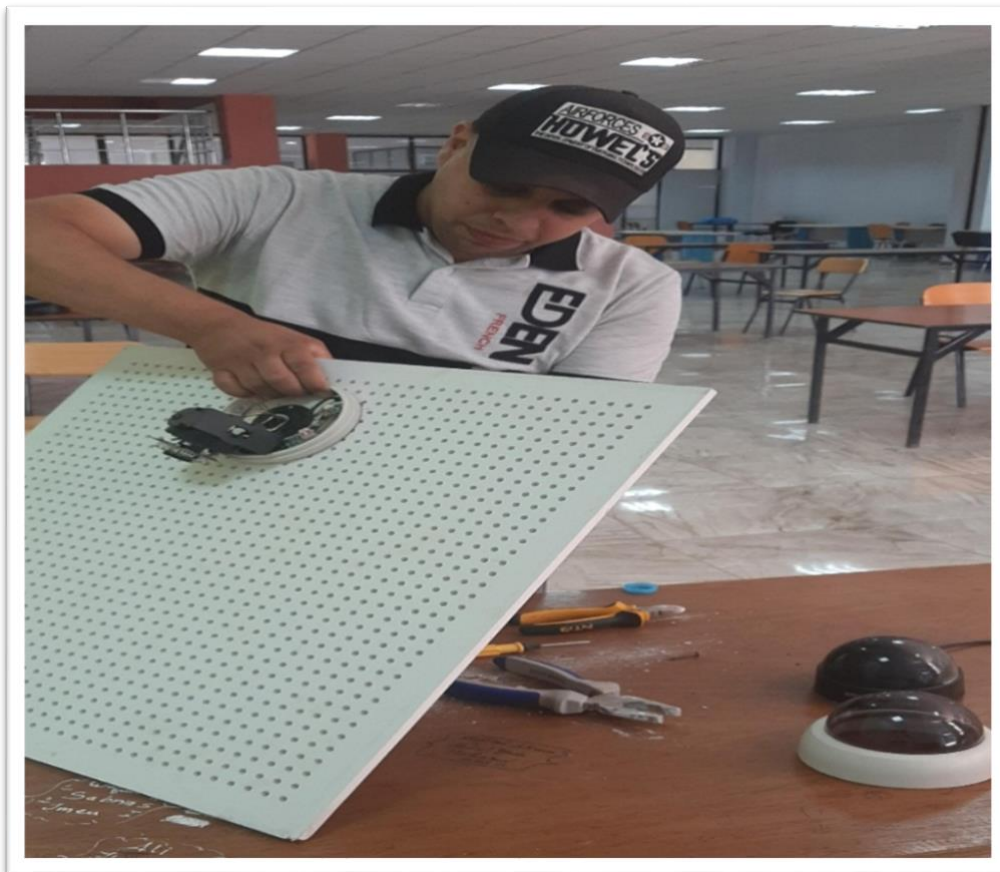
fixée la caméra a la plaque de faux plafond
